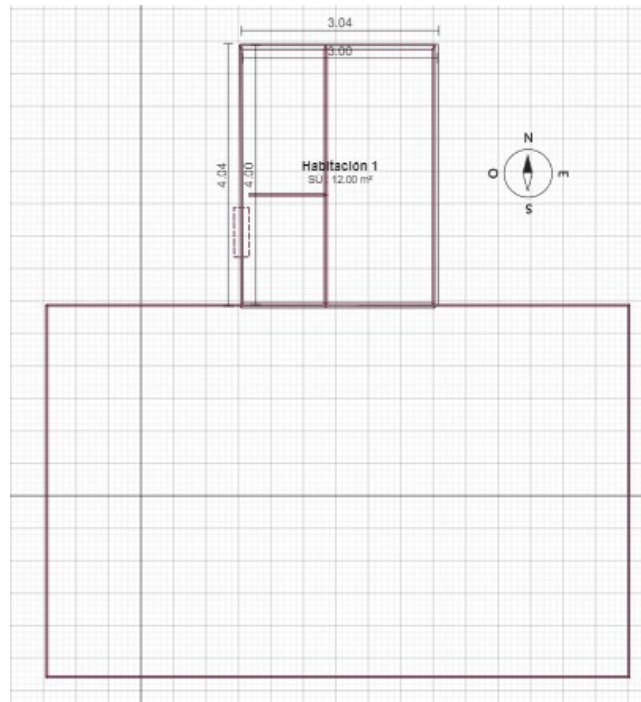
Tercera planta de la vivienda familiar Escala 1:50
